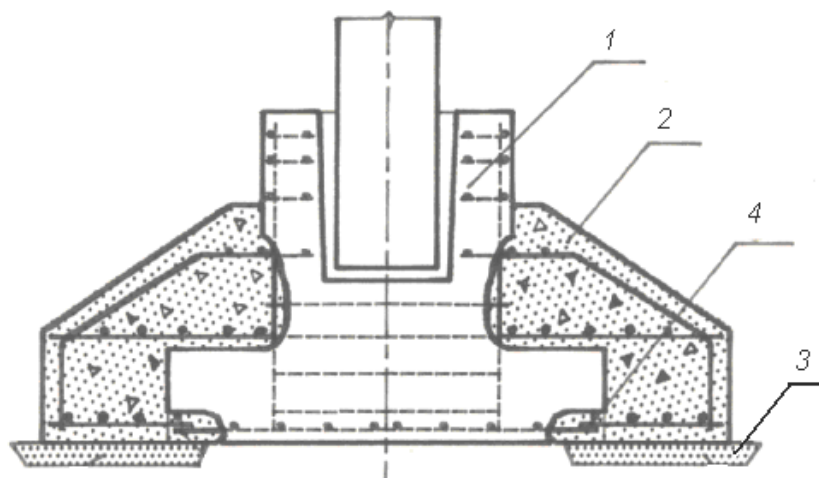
Уширение подошвы фундамента под колонну: 1 – существующий фундамент; 2 – наращивание части фундамента; 3 – щебеночно-песчаная подготовка; 4 – сварка
